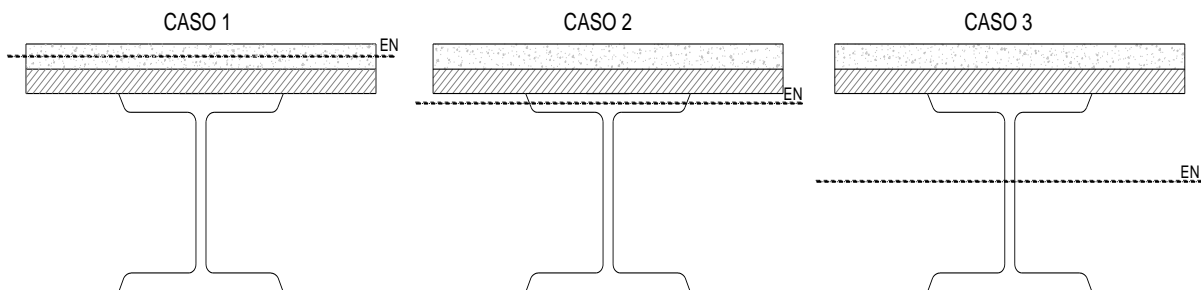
Posición del eje neutro en la sección compuesta (perfil metálico y losacero)
